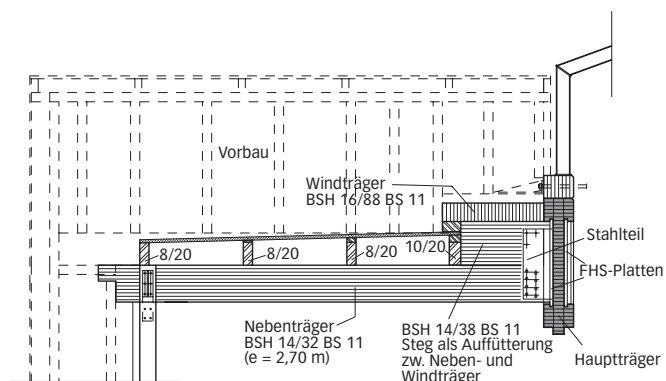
Detailschnitt durch Tagungsraum mit Haupt-, Neben- und Windaussteifungsträger
